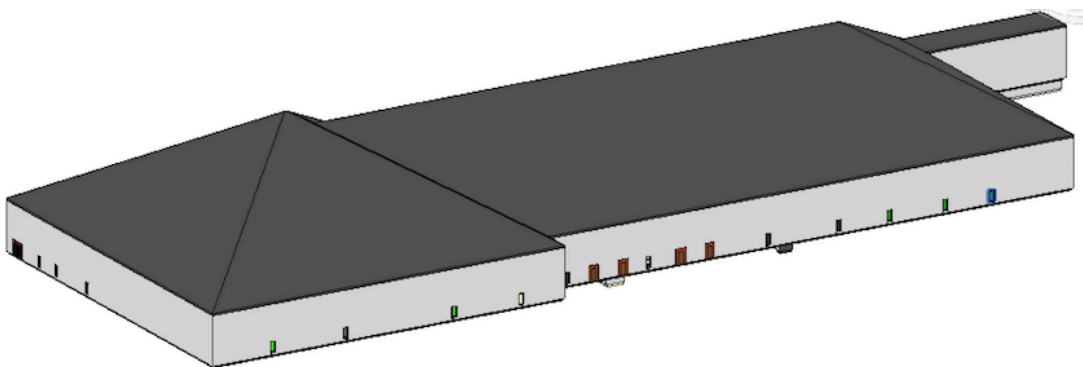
Modelo de Arquitetura da instalação – vista geral exterior
